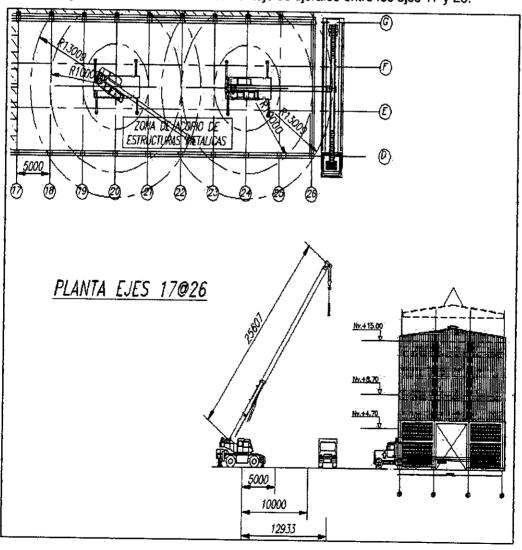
Plan de desmontaje de tijerales entre los ejes 17 y 26.
